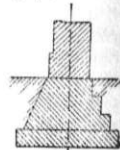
Бетонный фундамент с уширением сверху и снизу.
